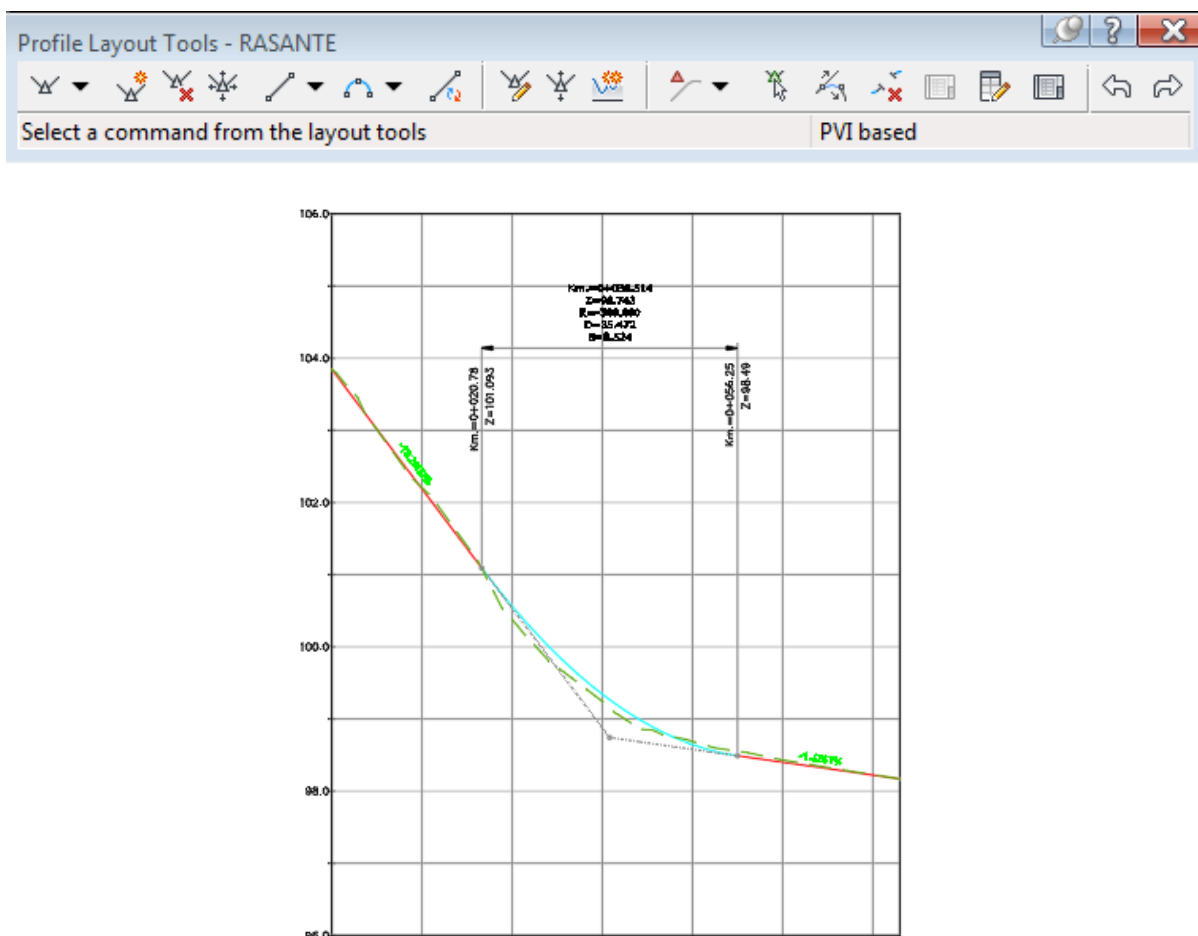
Ferramenta de criação de perfil longitudinal / Perfil Longitudinal
